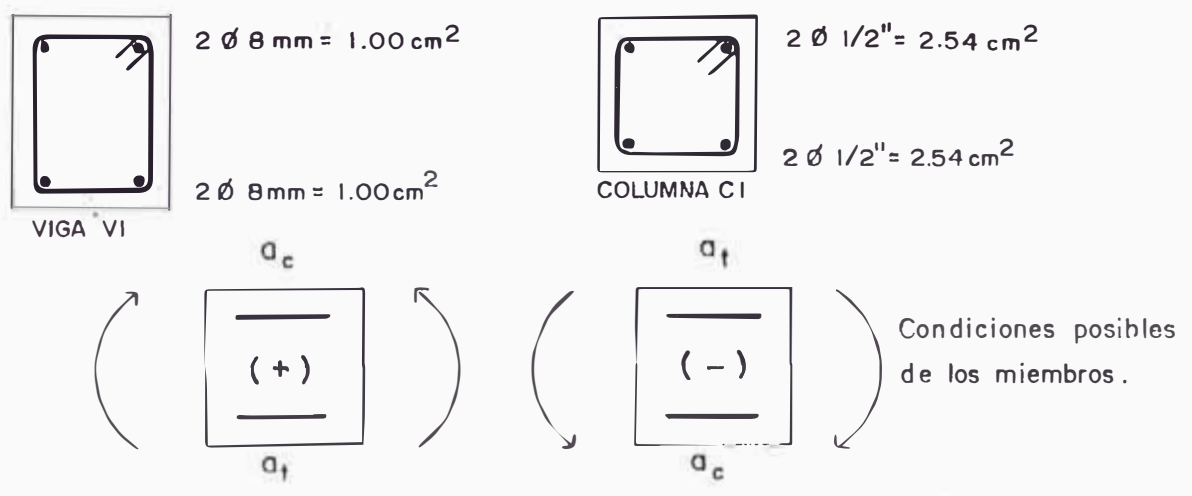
ACERO CONSIDERADO EN LAS VIGAS Y COLUMNAS PARA LAS PROPIEDADES PLASTICAS.
